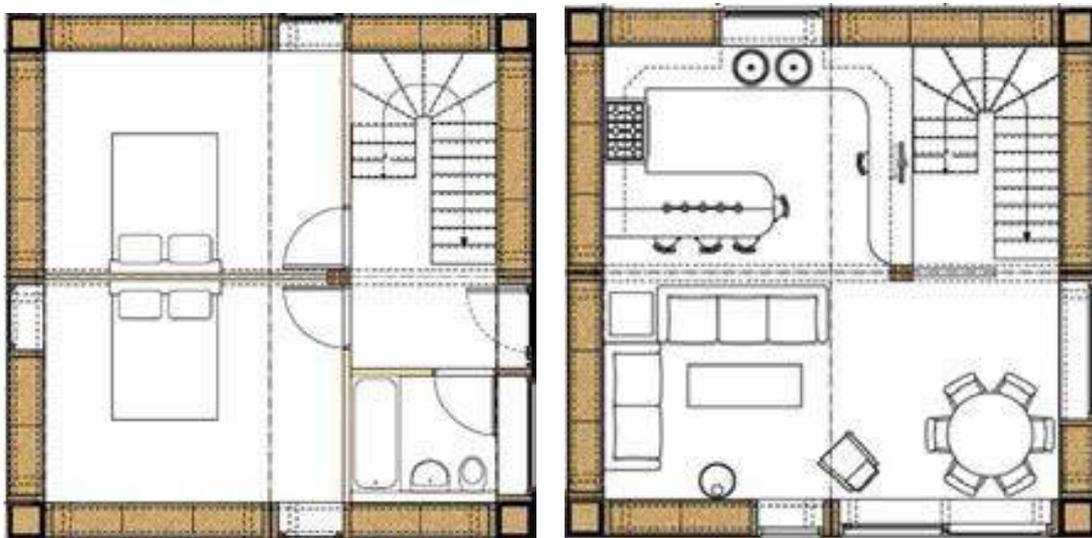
Disegni della BaleHouse originaria. Pianta piano terra e piano primo (fuori scala) (ModCell, 2013)
